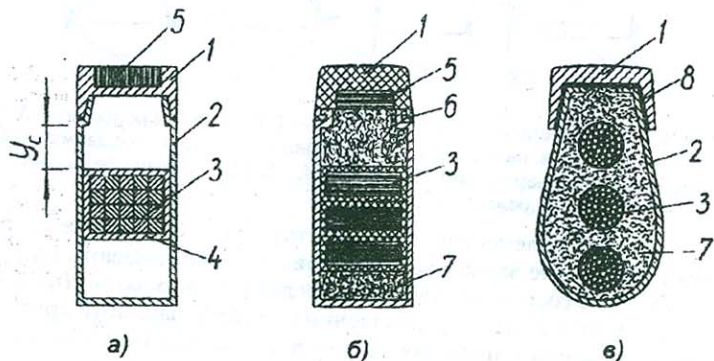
Конструкция рельса-струны: а — со струной из проволок; б — из лент; в — со струной-тросом; 1 — головка рельса; 2 — корпус; 3 — струна; 4 — защитный кожух струны; 5 — дополнительная струна; 6 — замок-защелка; 7 — наполнитель; 8 — клей
